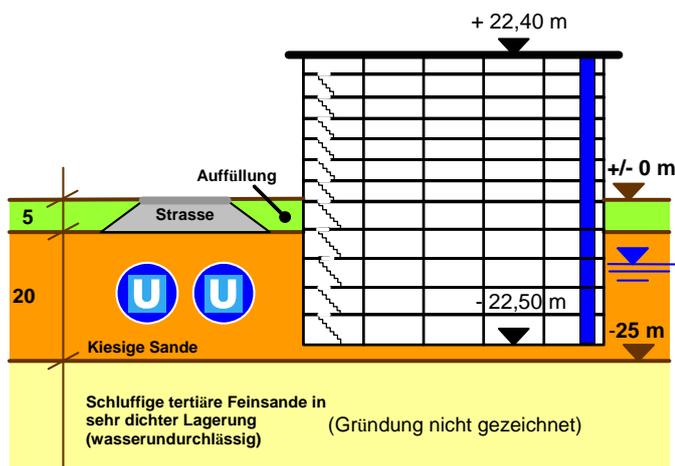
Schnitt durch das zu errichtende Bauwerk
